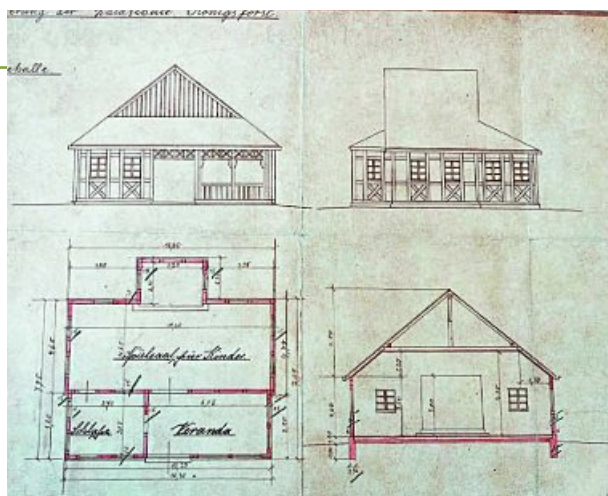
Ansicht und Grundriss der „Lesehalle“. 1922. Ausschnitt.
